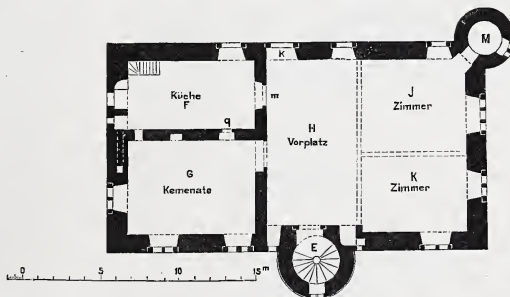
Grundriss vom I. Stockwerk.
